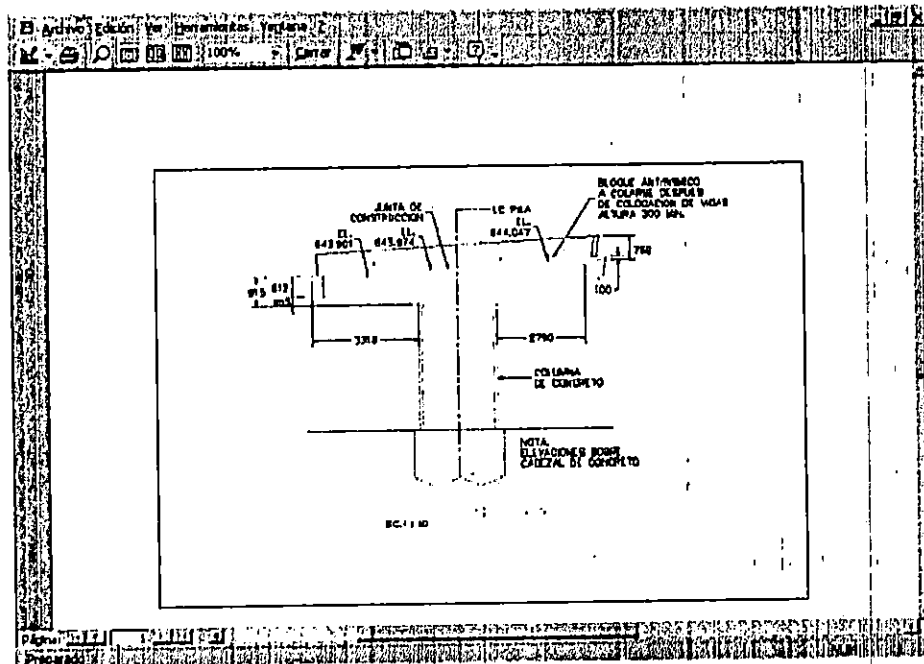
Vista Previa de Planos estructurales. Elevación Central de Pila del Puente 2Av. Sur
